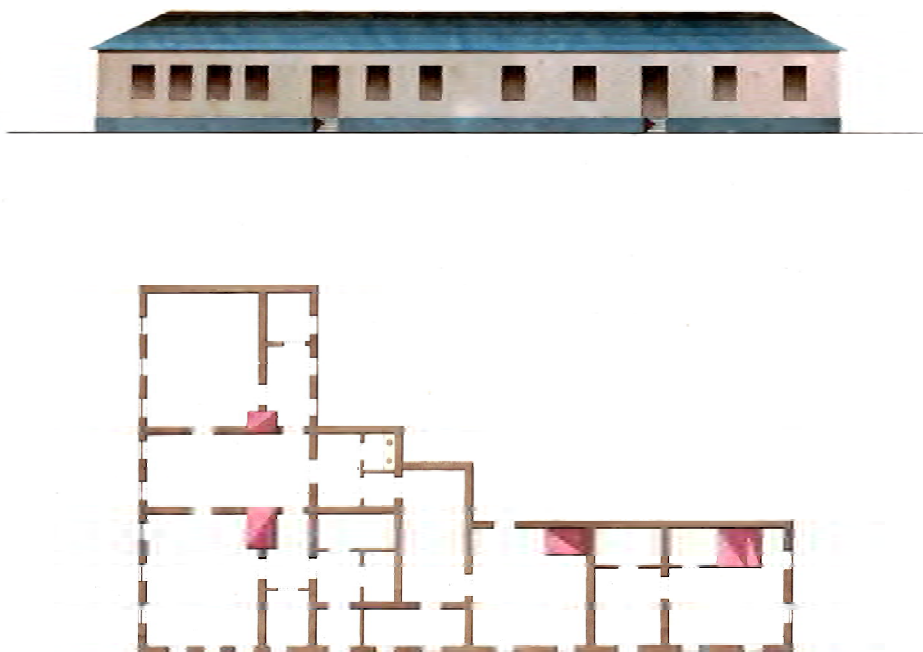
Фасад и план флигеля при господском доме Рябкинского завода
